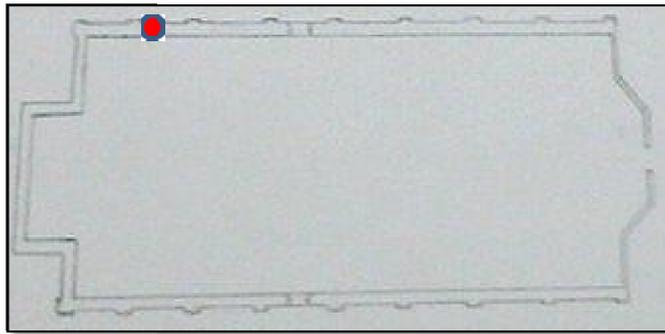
Planta baixa da Igreja com indicação do local, na fachada norte onde foi retirada a amostra.
